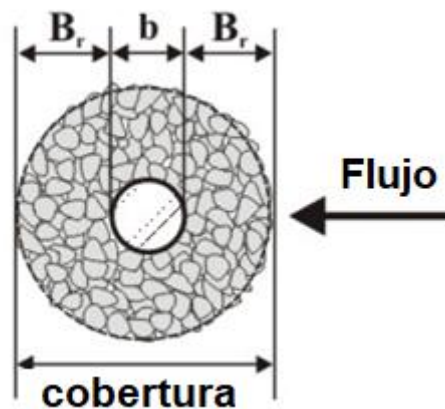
Esquema de la capa de enrocamiento, Melville Bruce (2008)
